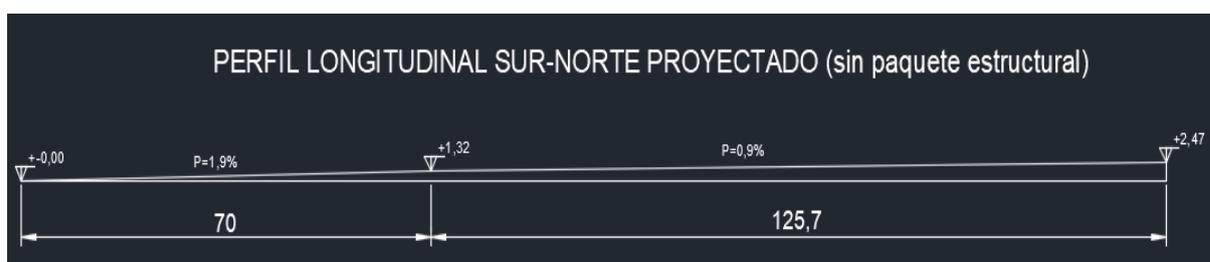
Plano Corte – Perfil longitudinal proyectado sin paquete estructural. Elaboración: Propia.
